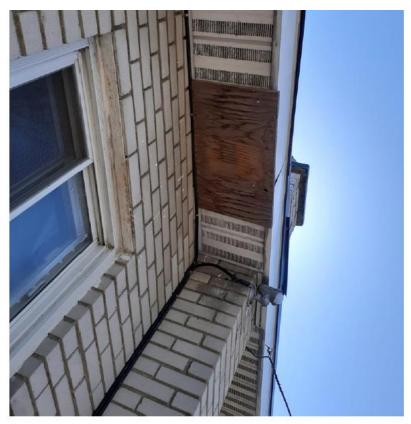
PANNEAU DE CONTREPLAQUÉ BOUCHANT LA CORNICHE
